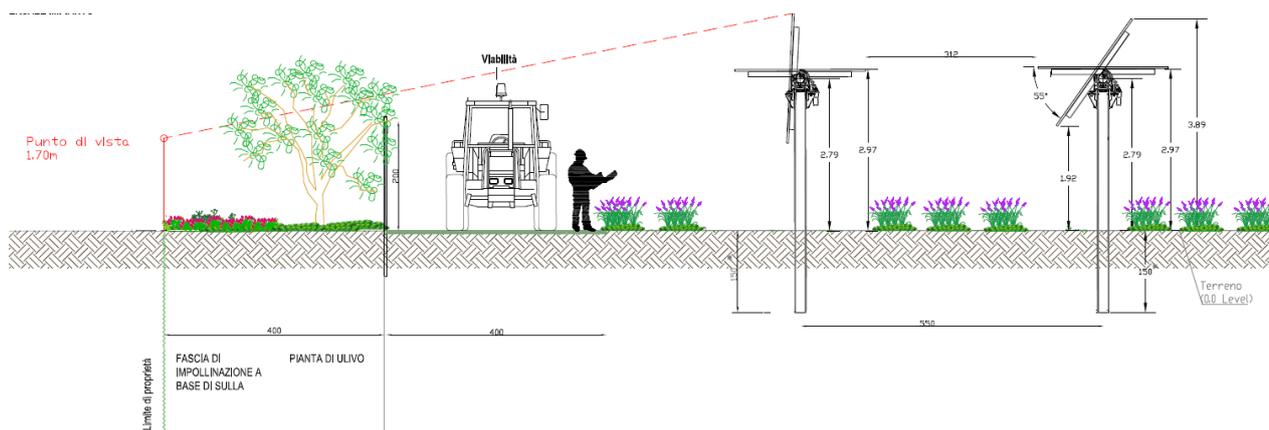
Sezione tipo della soluzione adottata con tracker alto (altezza in corrispondenza dell'asse di rotazione pari a 279 cm) ed interasse di 5,5 m
